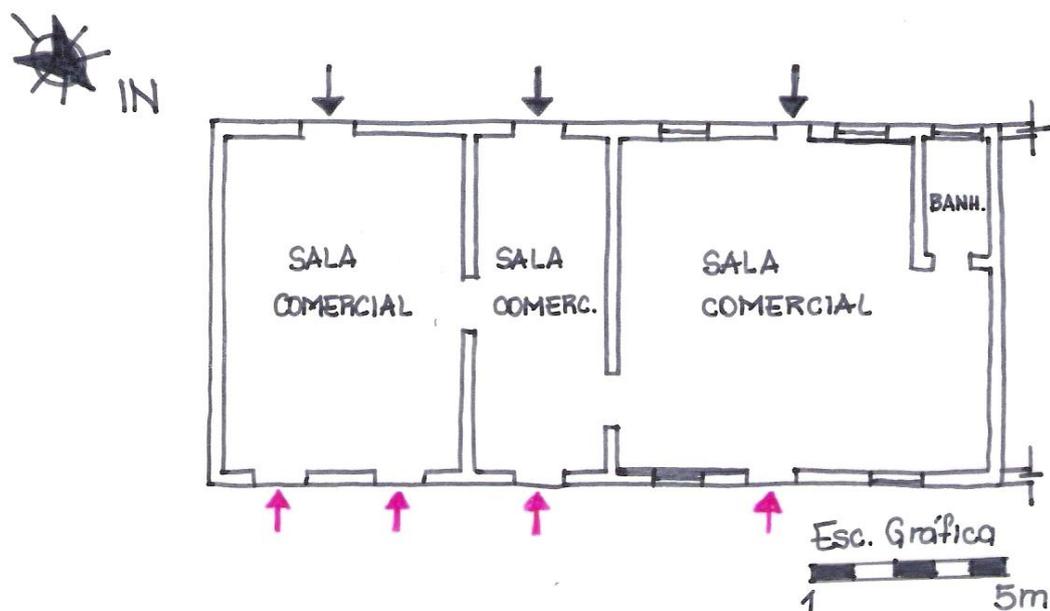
Provável planta baixa esquemática das salas comerciais da edificação.
